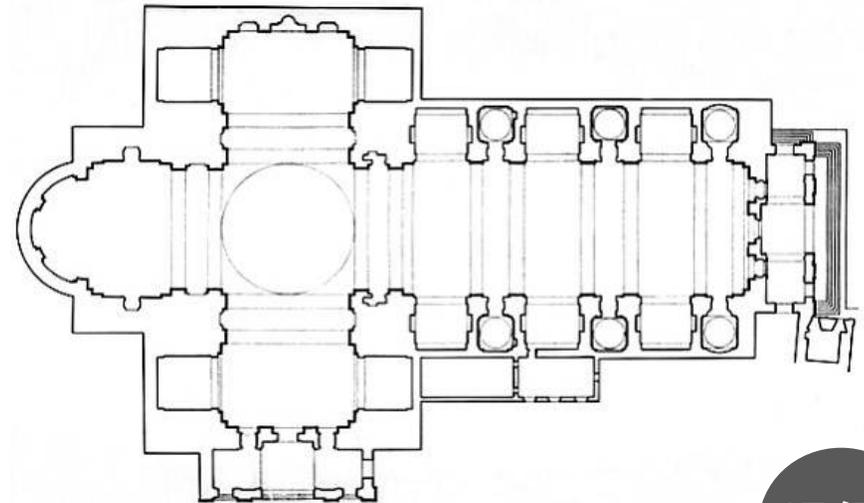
Planta da Basilica di Sant'Andrea – Mantua, Itália – Arqto. Albertii
